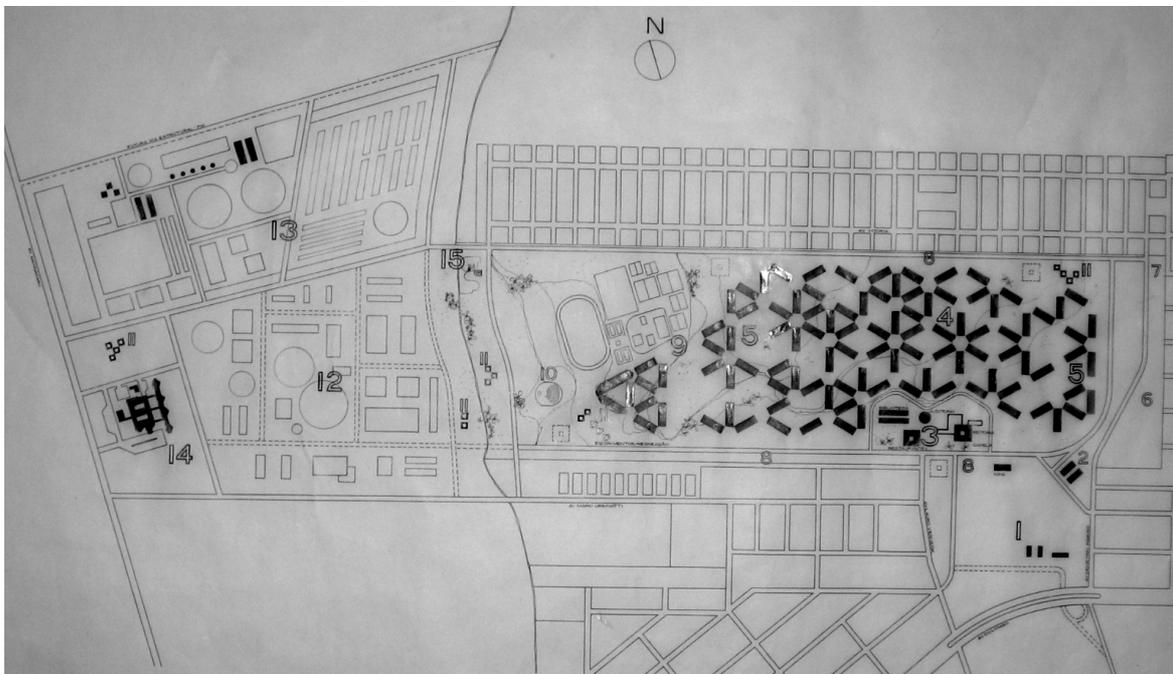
2º Plano Piloto do Câmpus-sede da Fuem – Plano Geral [1977].
